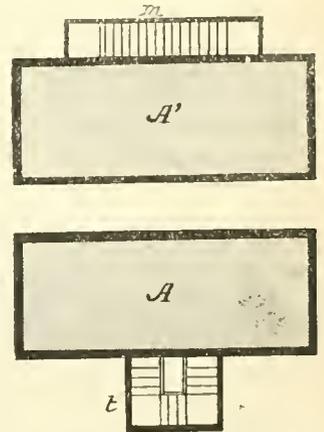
Plan d'escaliers construits hors les murs d'une maison.
